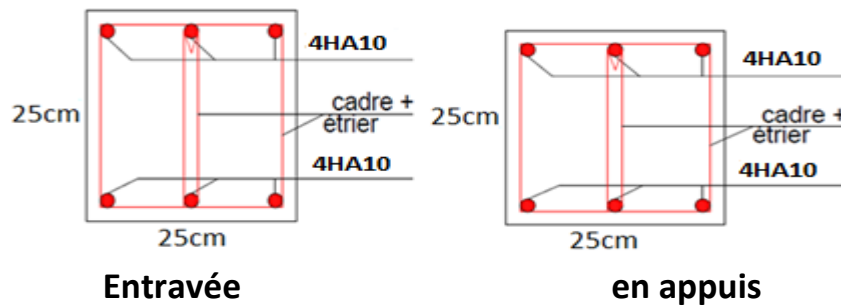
Schéma ferrailage poutre chaînage en appuis et en travée
